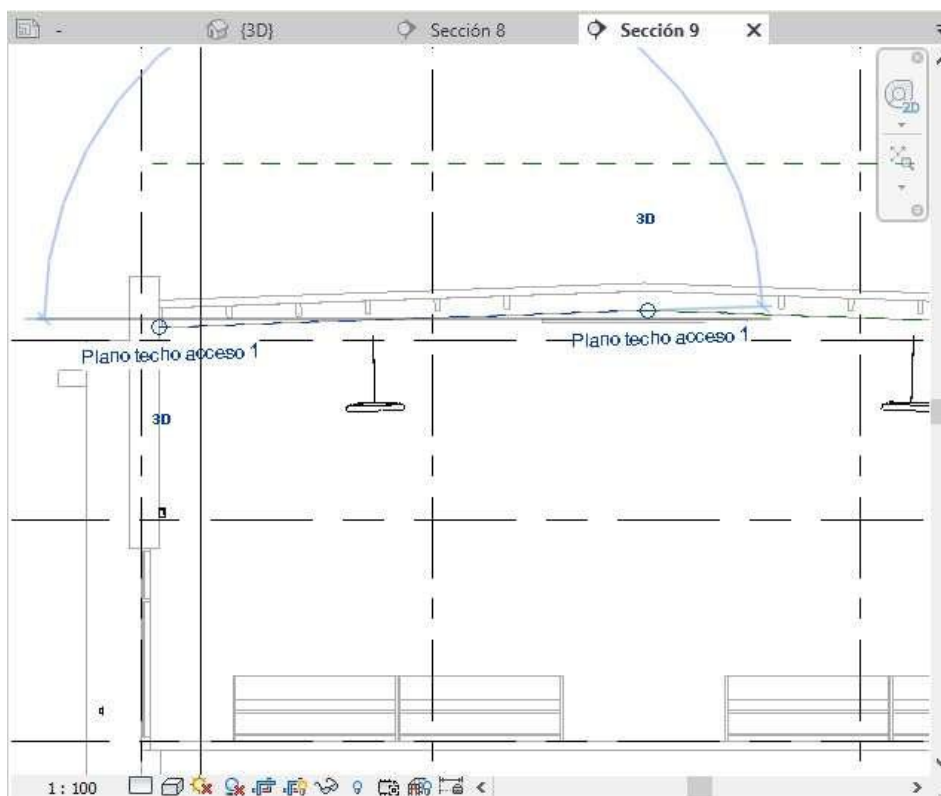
Colocación luminarias sobre plano de trabajo definido
